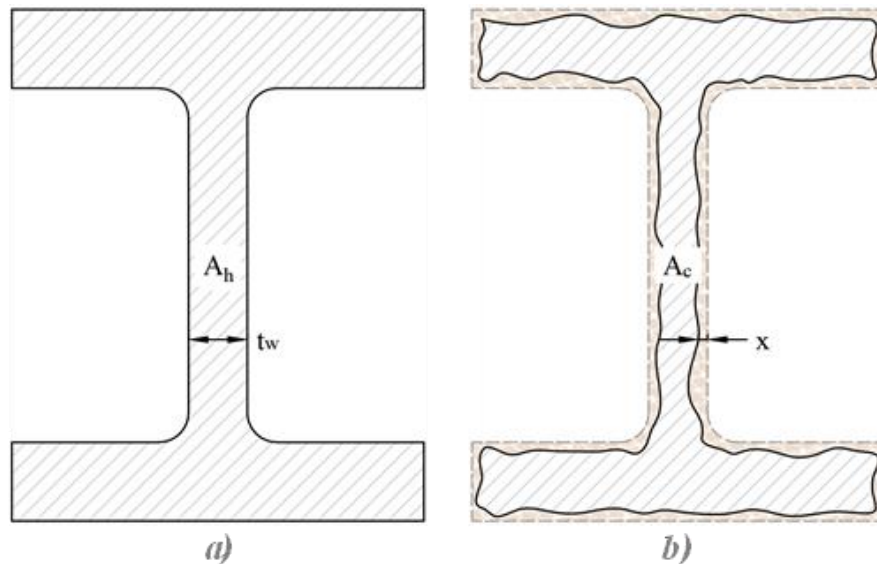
Corrosión de elementos de acero: a) Sección transversal (A_h) y ancho de alma (tw) en estado sano. b) Sección transversal bajo efectos de corrosión (A_c), penetración de la corrosión (x). Fuente: adaptado de Zhang et al. (Zhang et al., 2014).
